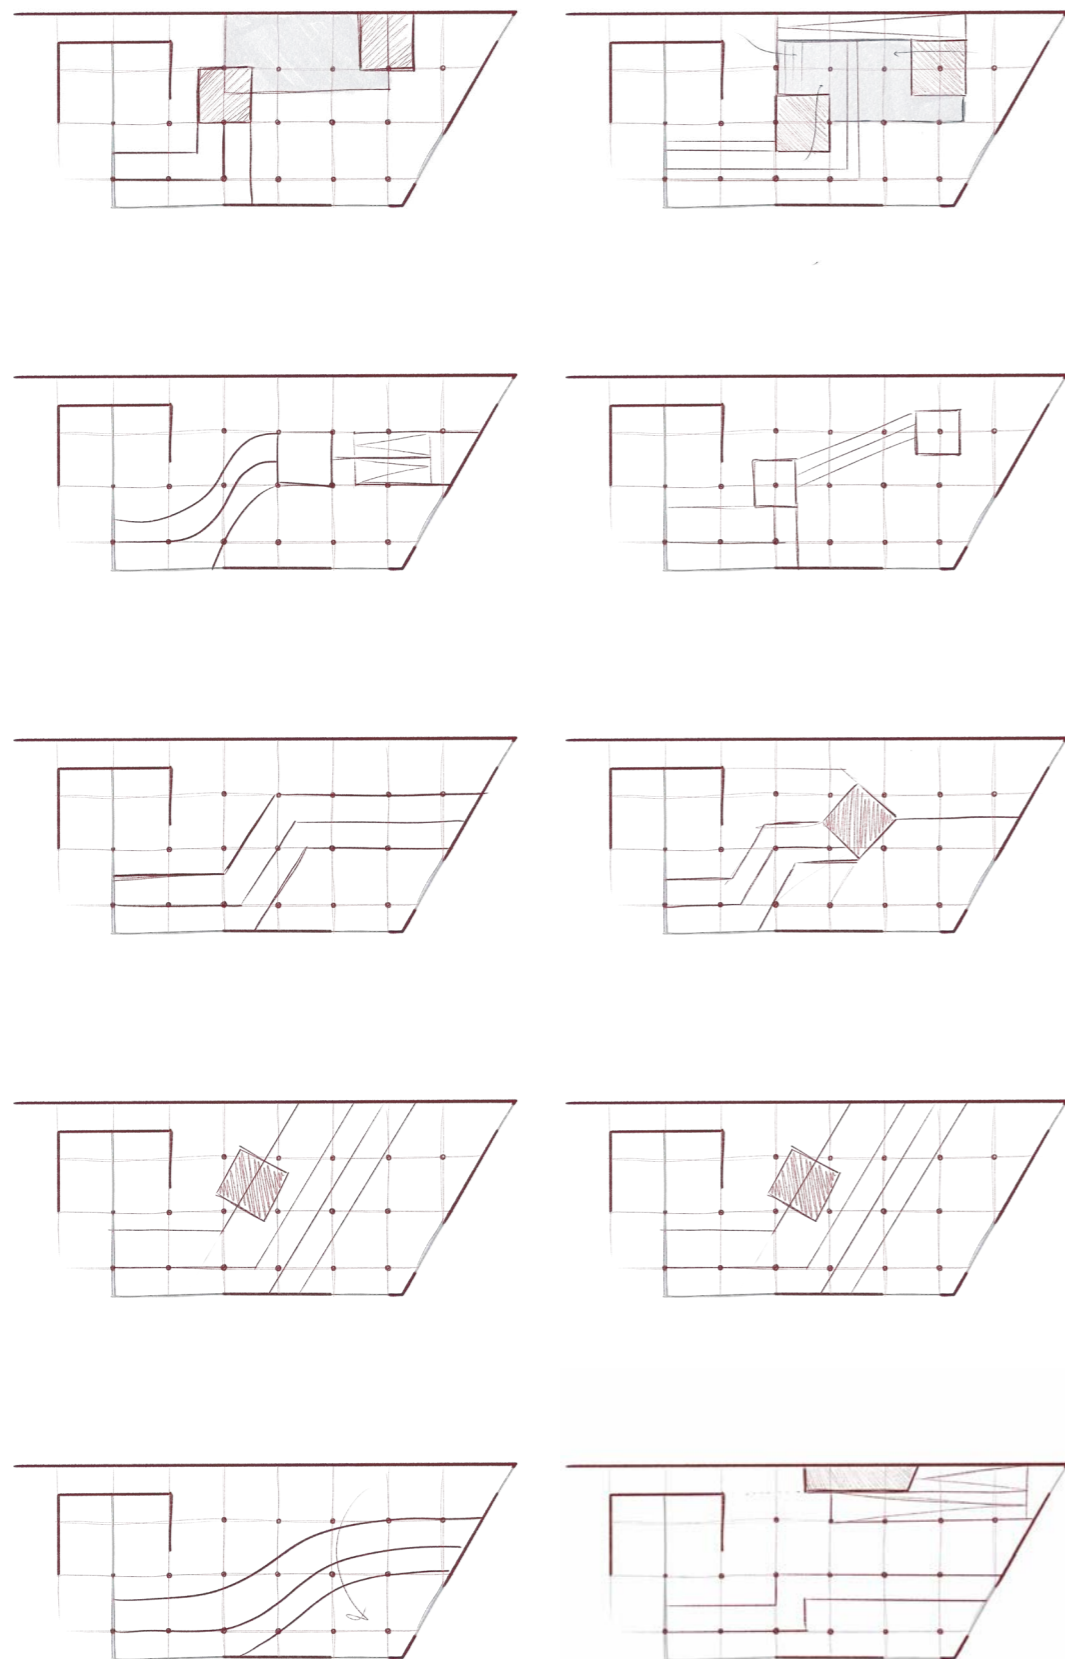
Conjunto de Esquícios em Planta, Estudo da Zona Infantil
